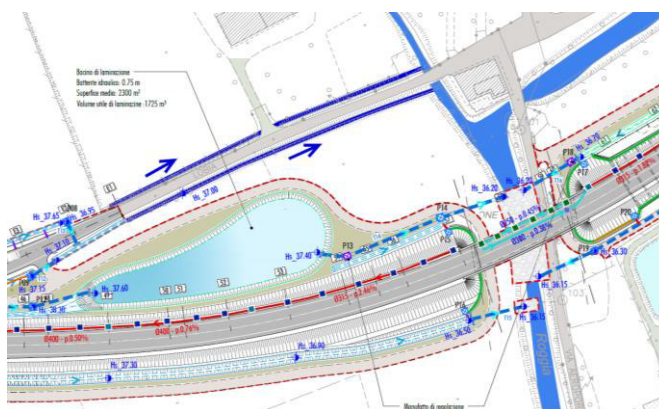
PLANIMETRIA DEL BACINO DI LAMINAZIONE
